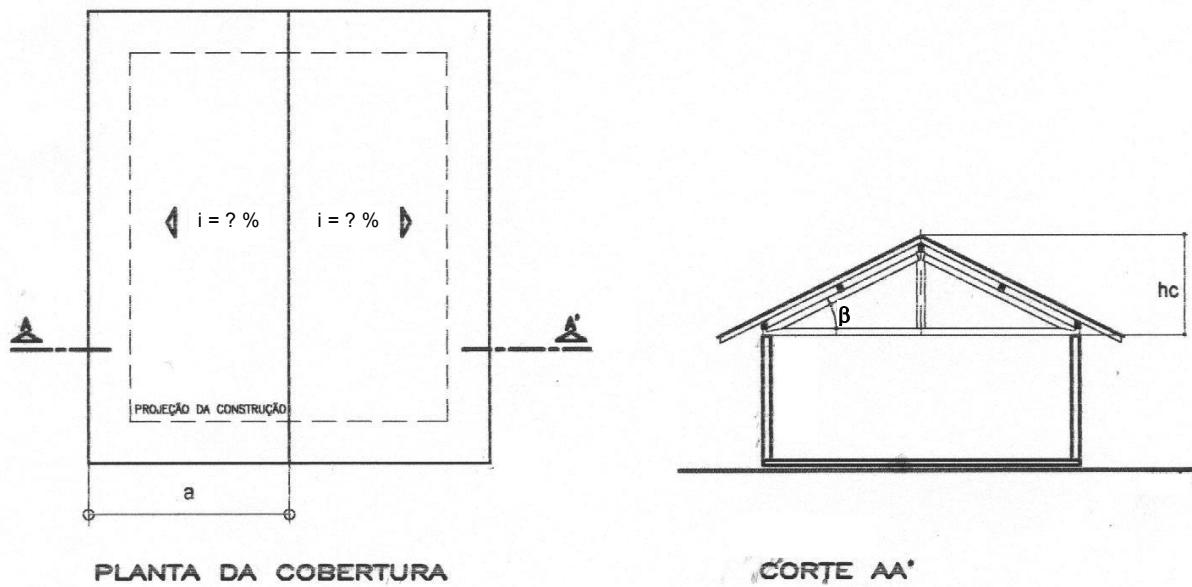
PLANTA DE COBERTURA E CORTE (sem escala)
